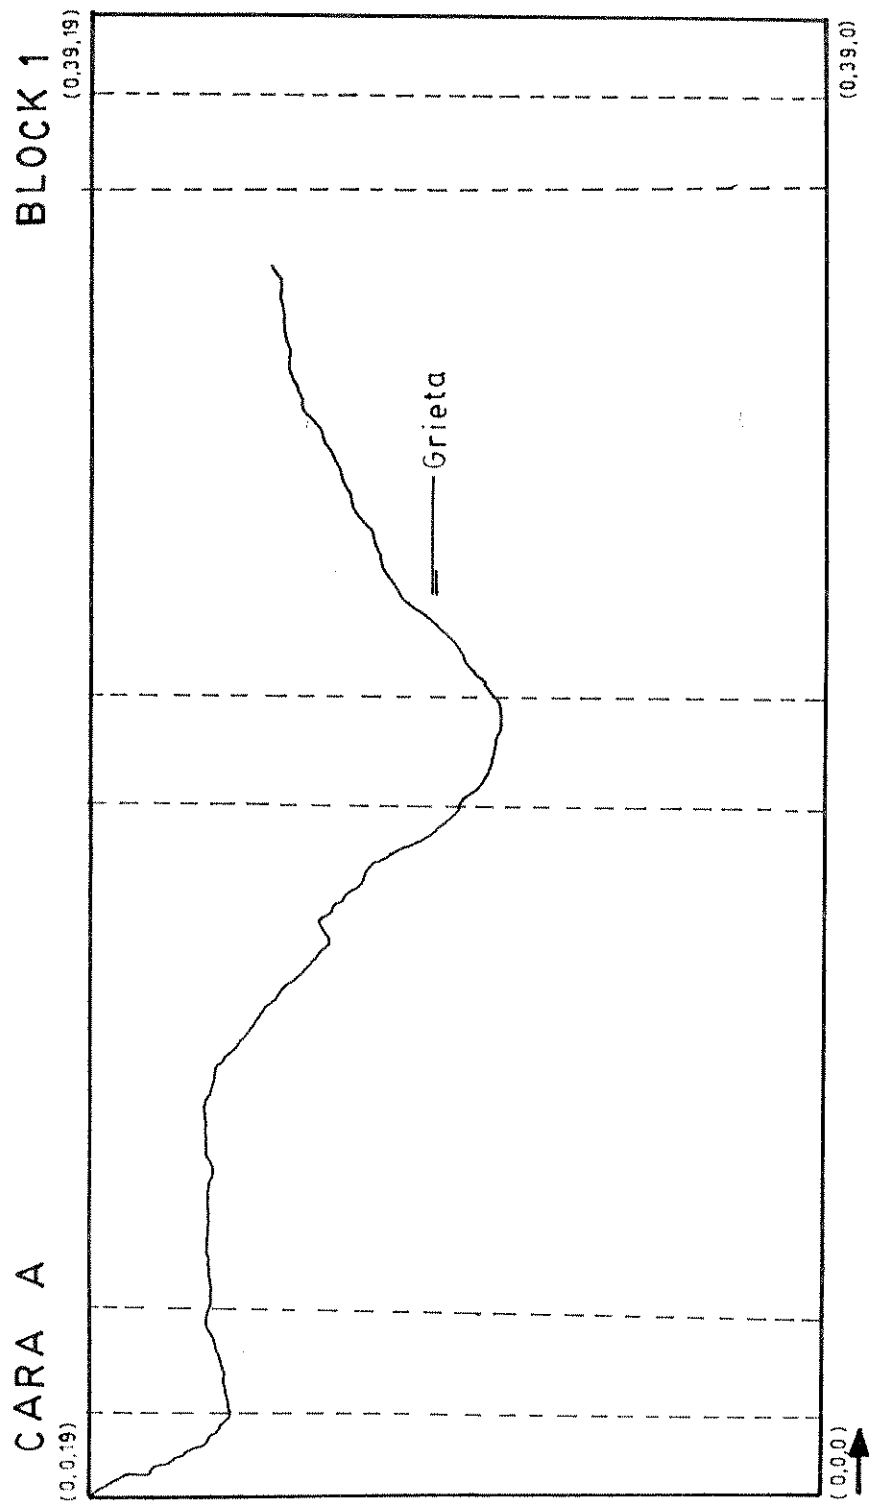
Grieta ocurrida por la carga de compresión en el primer block ensayado.
